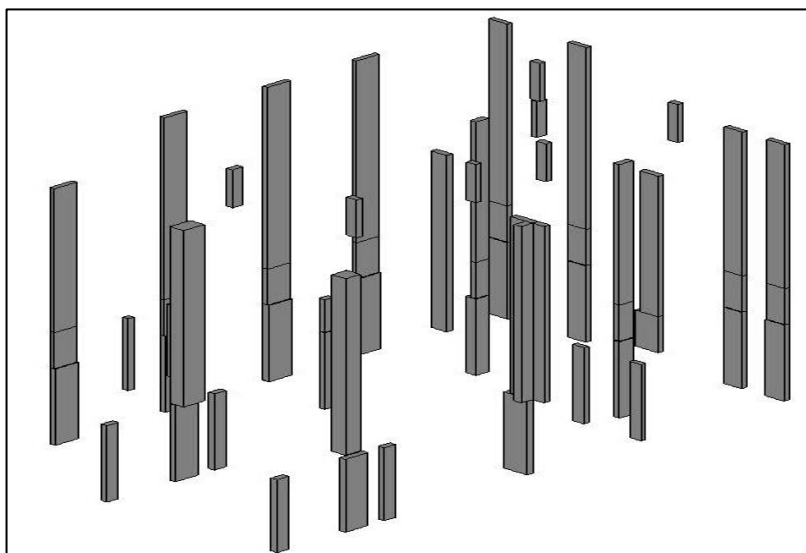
Proceso de ubicación de las columnas según plano de cimentaciones
